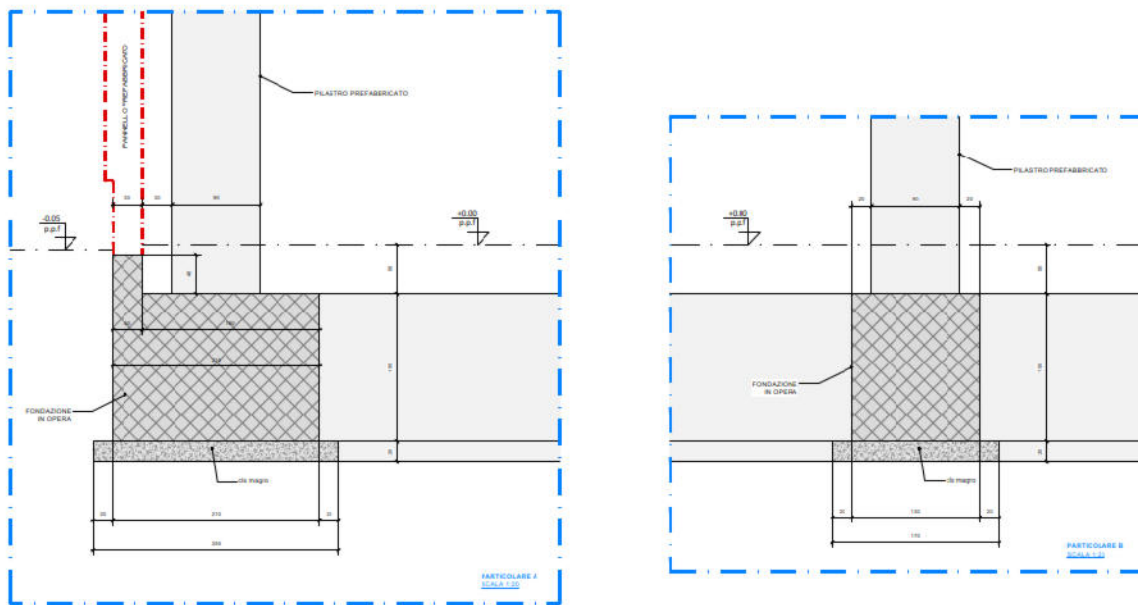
Particolare in scala 1:20 delle opere di fondazione (da Specifica Tecnica Thales)
